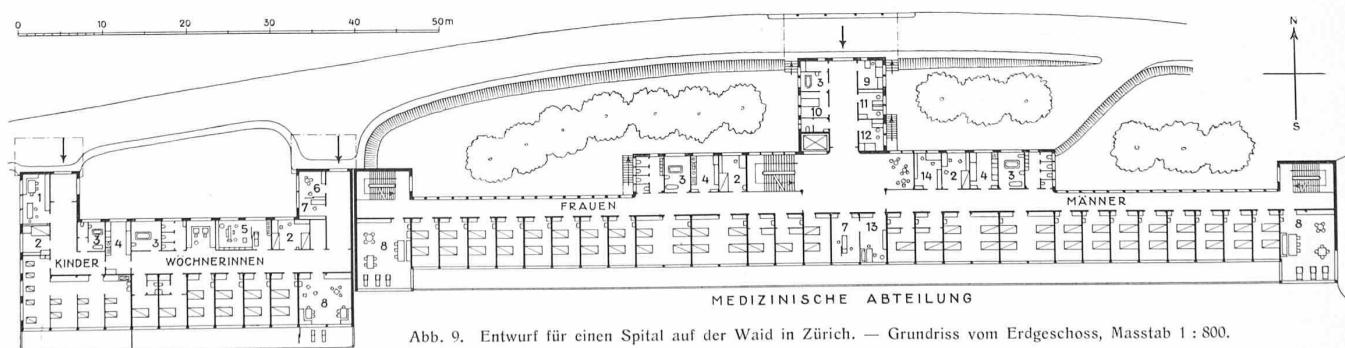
Entwurf für einen Spital auf der Waid in Zürich. — Grundriss vom Erdgeschoss, Maßstab 1:800.
